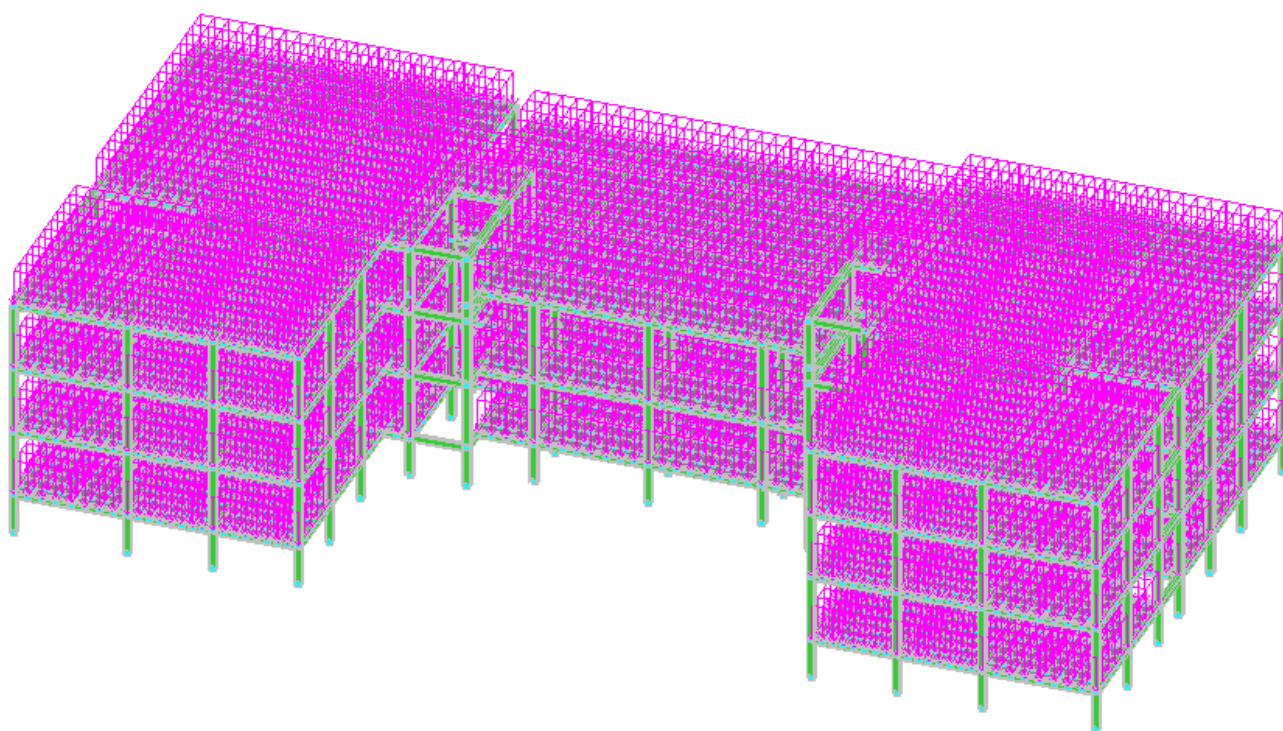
Задание нагрузок от веса плит перекрытия и конструкции пола
